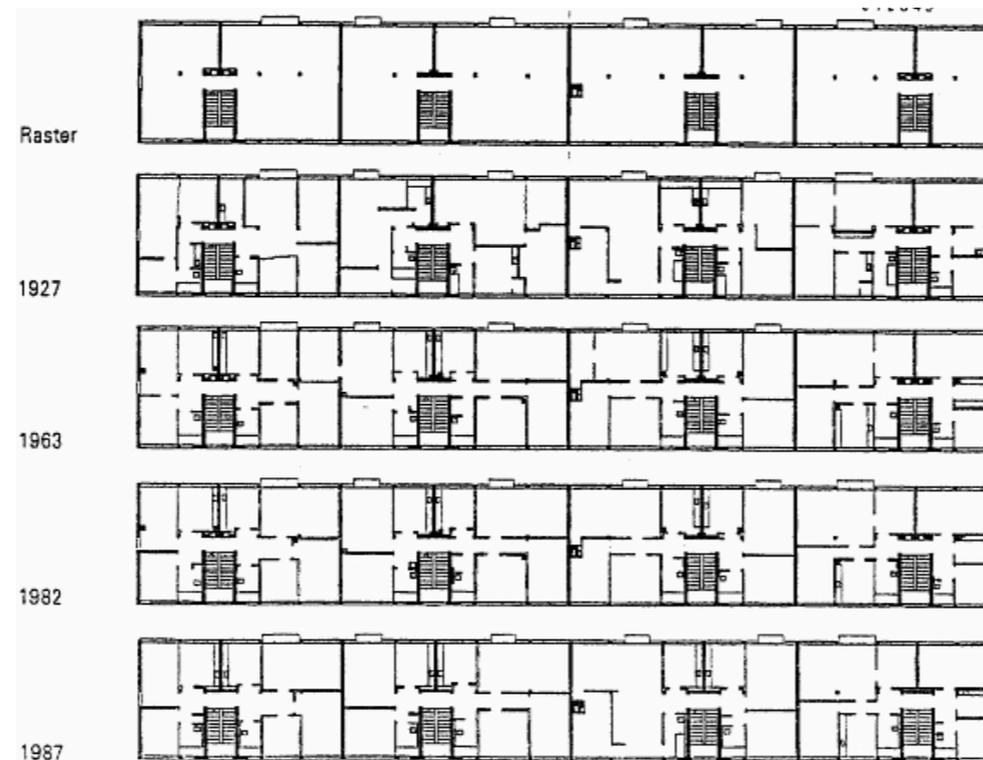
Mies van der Rohe, Wohnblock, Stuttgart, Wandel der Grundrisse
